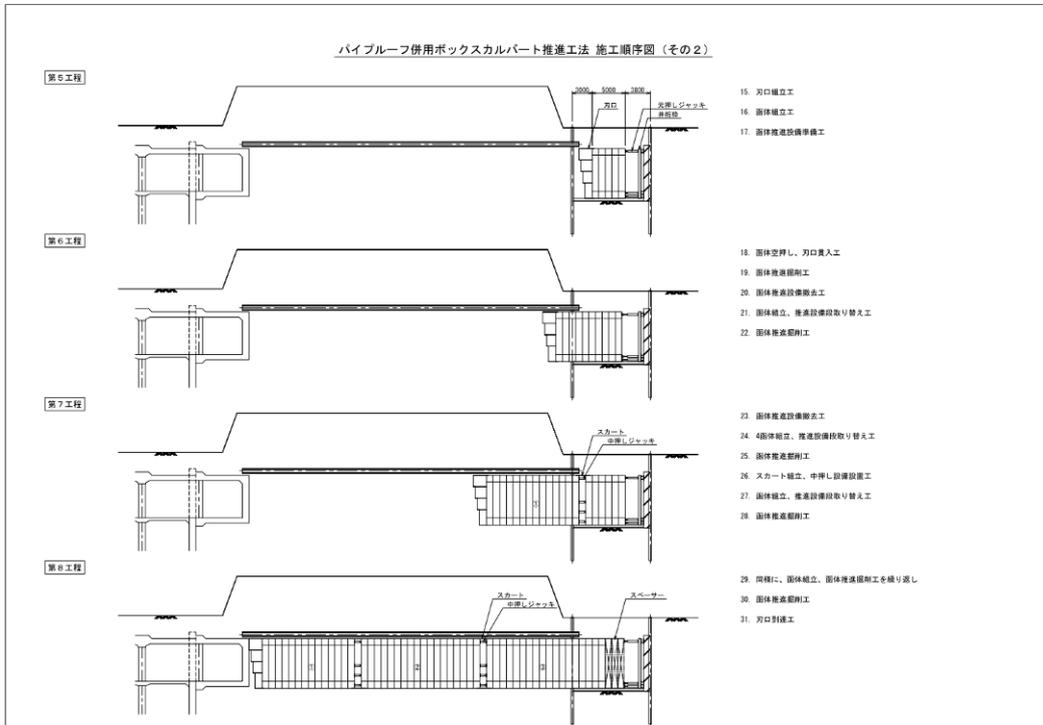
パイプルーフ併用ボックスカルバート推進工法施工手順図
